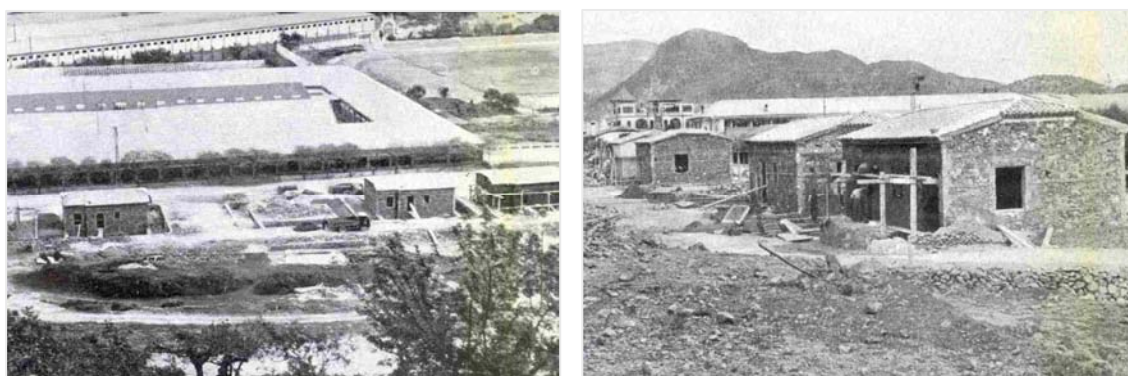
10. LA VALL D'UIXÓ. Viviendas de la colonia Segarra en construcción junto a la fábrica (1945).
